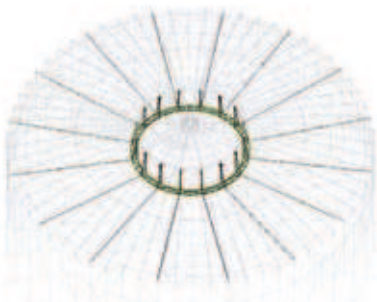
Stěna zvonu plynojemu, detail styku prvků stěny
